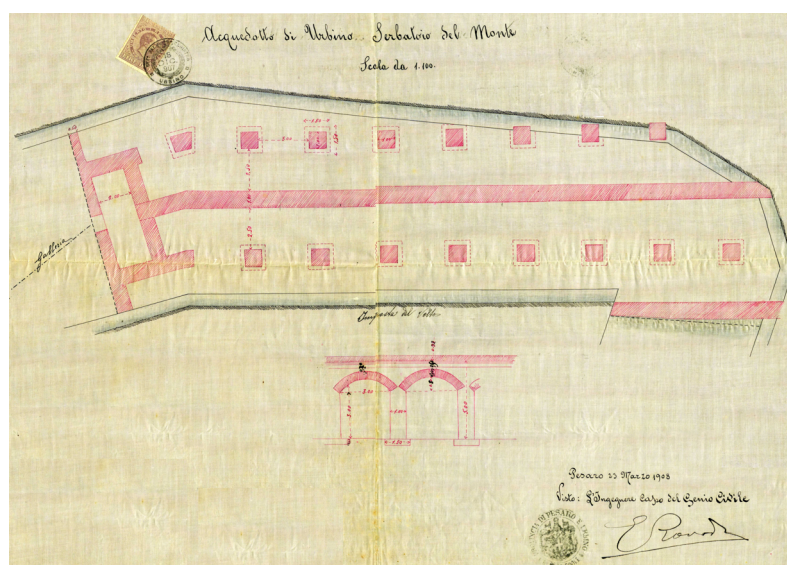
Planimetria delle cisterne del Monte. (Per gentile concessione dell'Archivio di Stato Sezione di Urbino)
